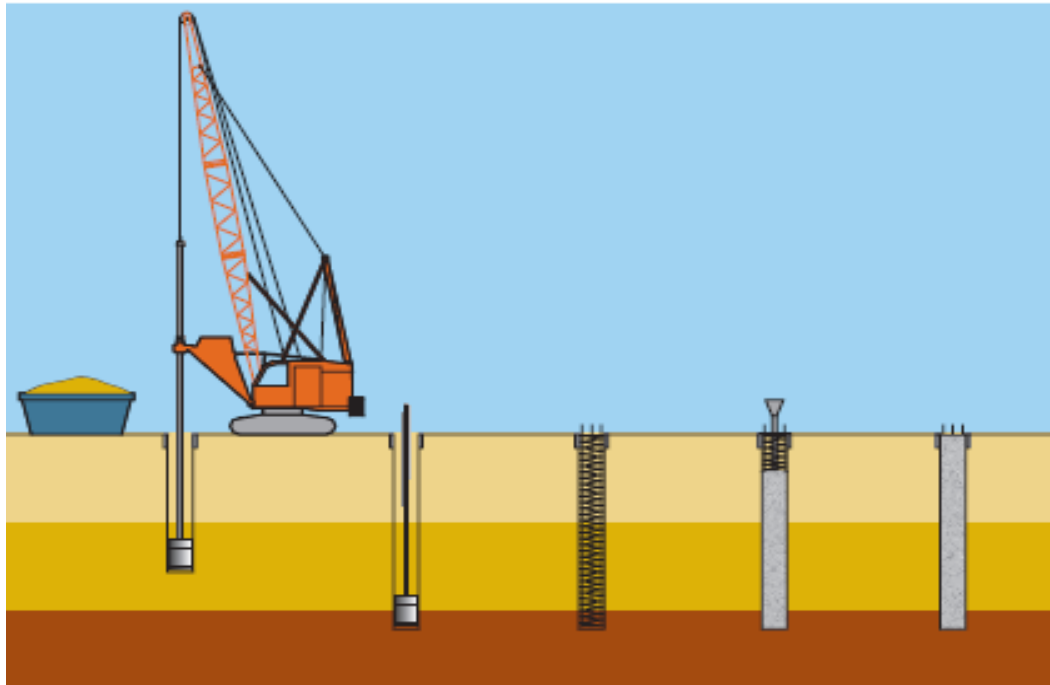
Proceso constructivo pilotes utilizando lodo bentonítico. Pilotes Terratest (2001).
